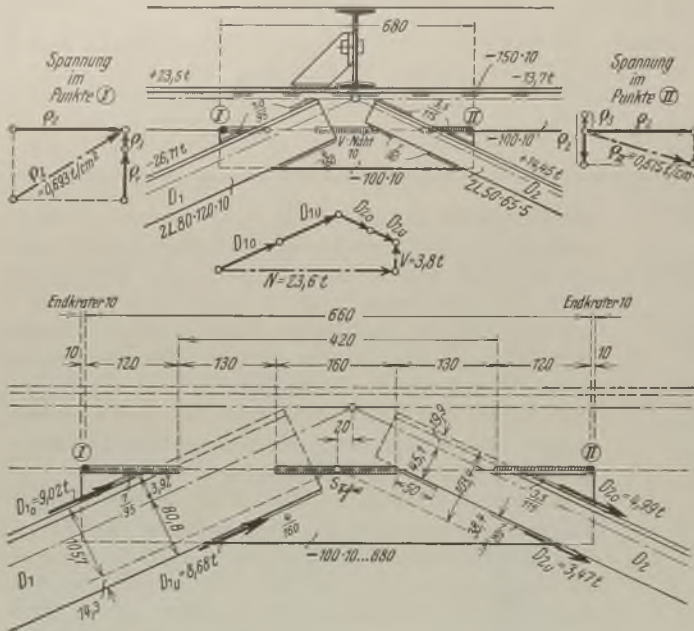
Knotenpunkt mit Verbreiterung des Gurtsteges durch ein stumpf gegengeschweißtes Blech.
